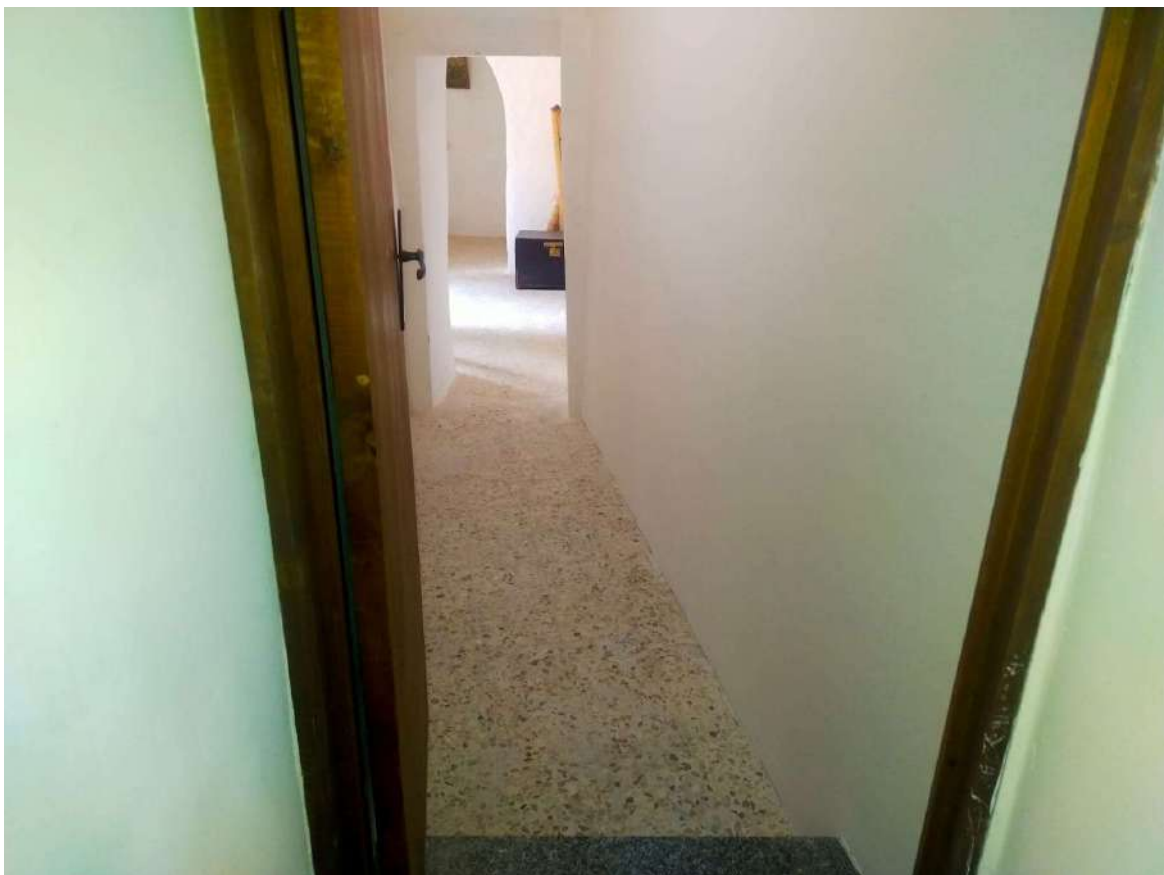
Corridoio che dall'abitazione consente l'accesso al trullo.
